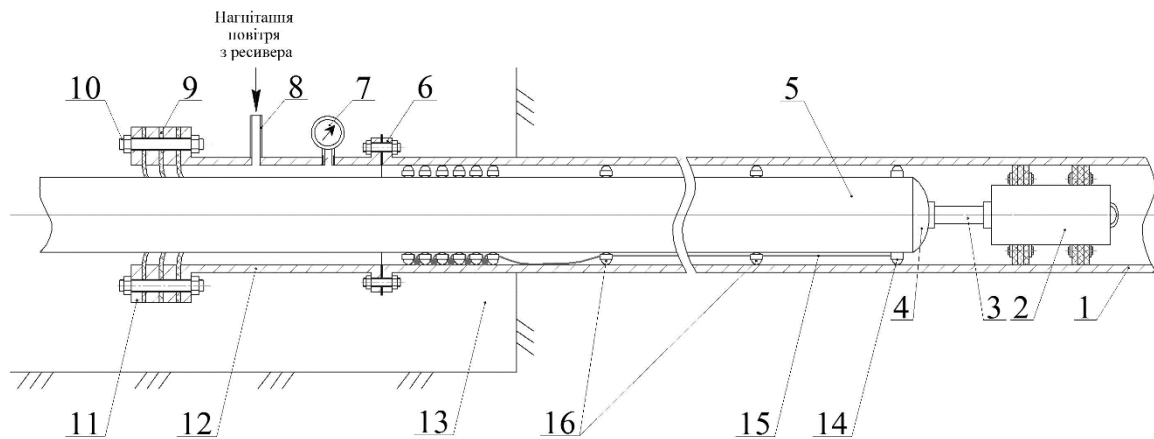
Конструкція пристрою для протягування поршнем нового поліетиленового трубопроводу в зношений сталевий з використанням опорно-центруючих кілець
